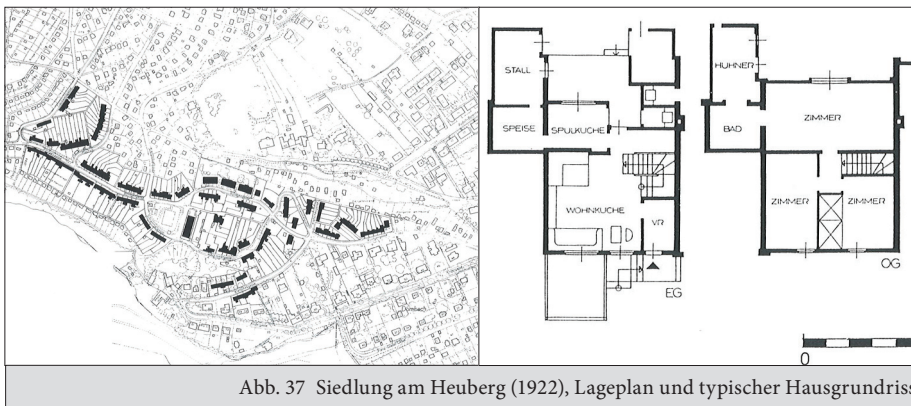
Siedlung am Heuberg (1922), Lageplan und typischer Hausgrundriss
